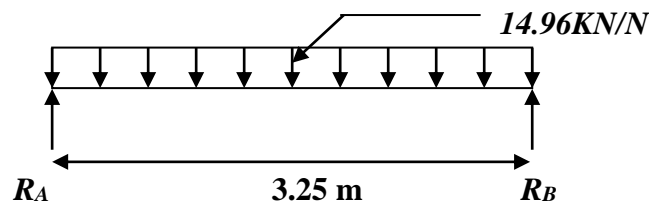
Schémas statique de la poutre palier à l'ELU.
